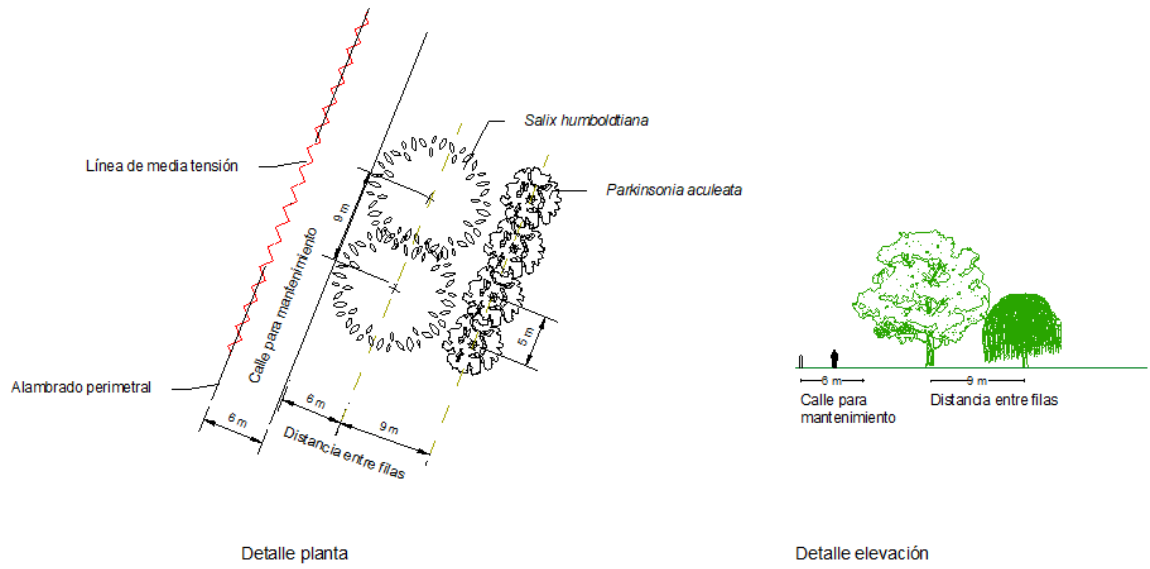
Detalle de plantación Tramo C – Sector Oeste y Nor Oeste
